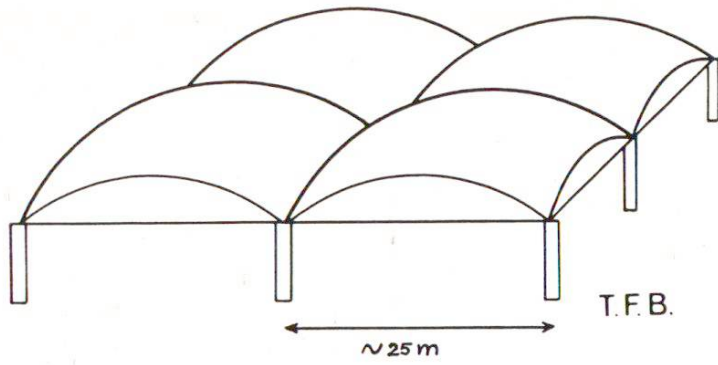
Toiture d'une fabrique. (Concrete Quarterly, 14, 11, (1952)
